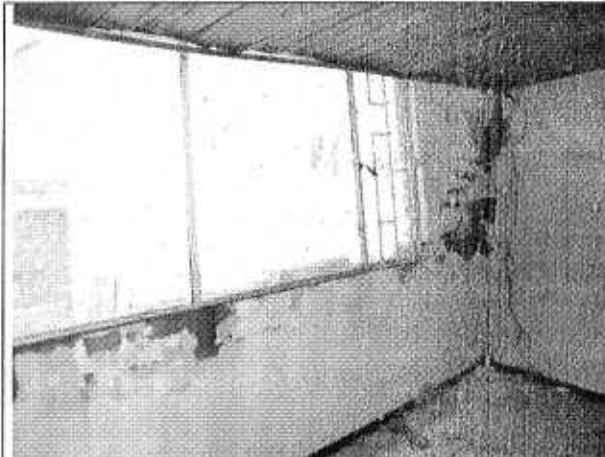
Vista interior del muro del segundo nivel del costado occidental de la unidad estructural posterior, señalado en la Foto 8. Presenta deformaciones y grietas severas.
